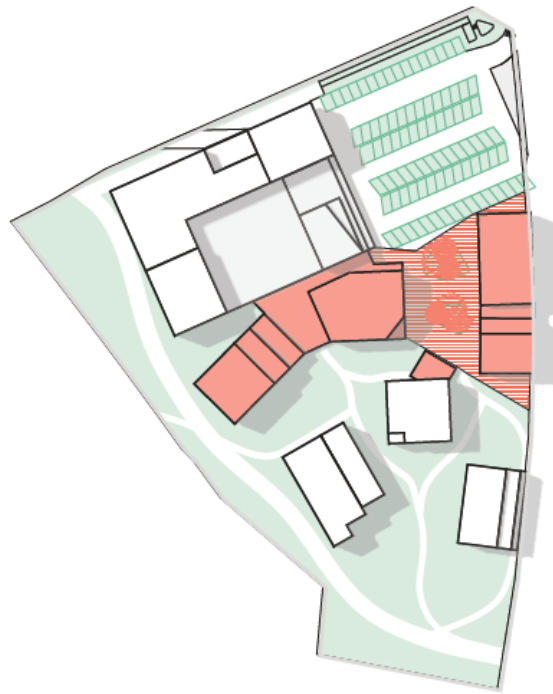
Plans du projet (Tetrarc 23-02-2024)
